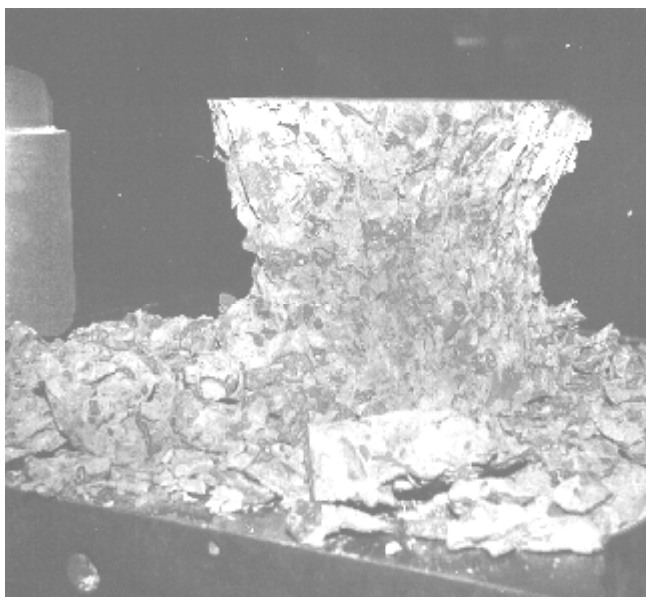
Общий вид разрушенного бетонного кубика при испытании на сжатие
